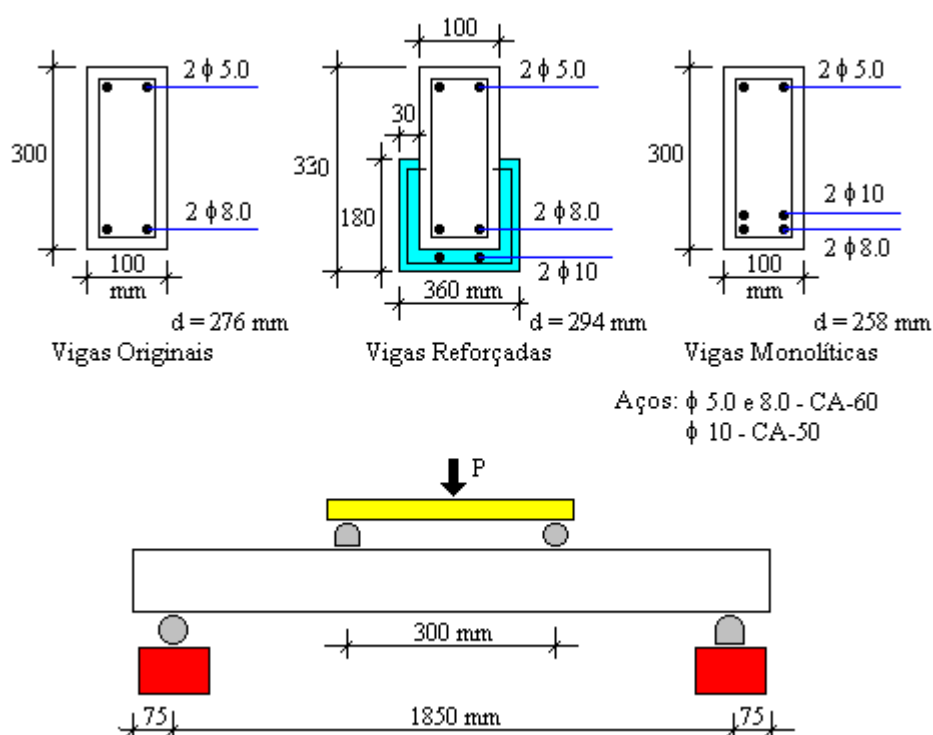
Seção Transversal das Vigas e Esquema do Ensaio
